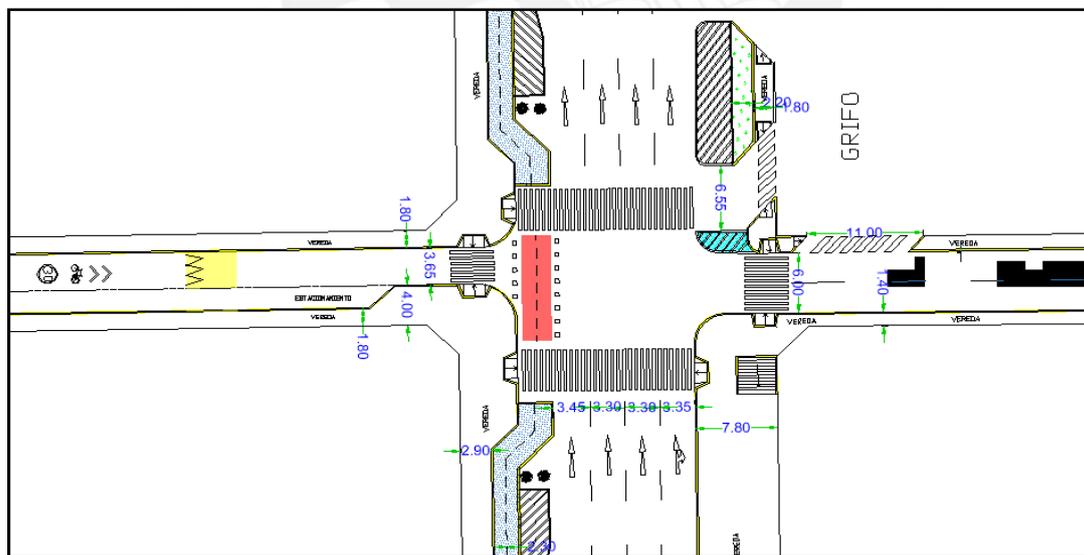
Vista en planta de situación propuesta en el cruce de la Av. Renovación y Bauzate y Meza.
